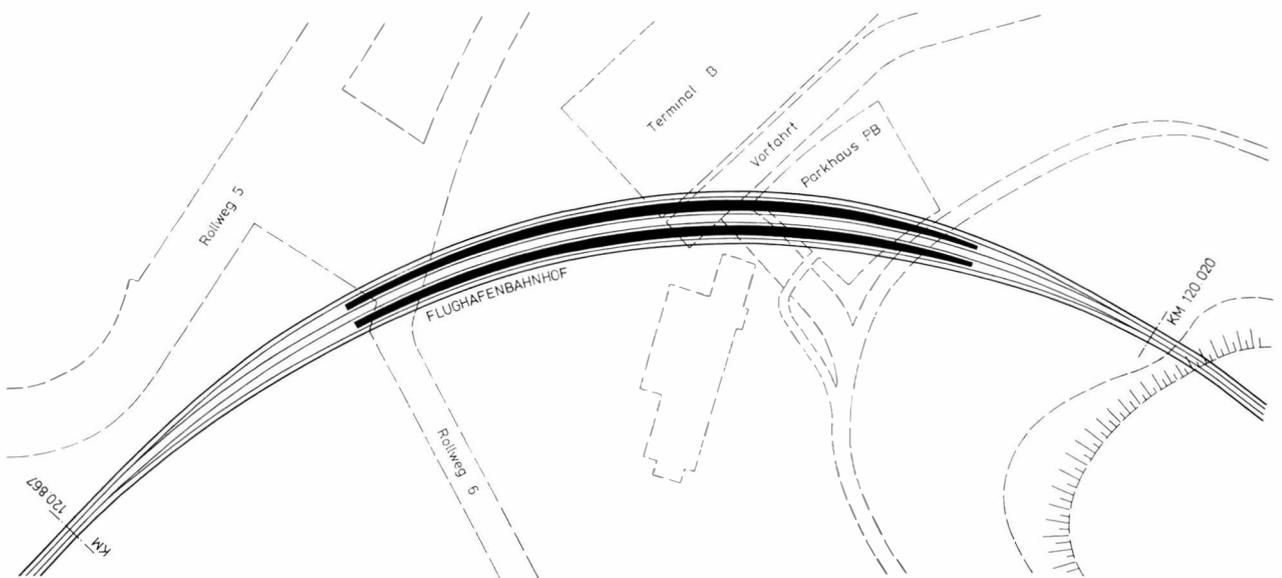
Grundriss des unterirdischen Perrongeschosses mit darüberliegenden Bauten
